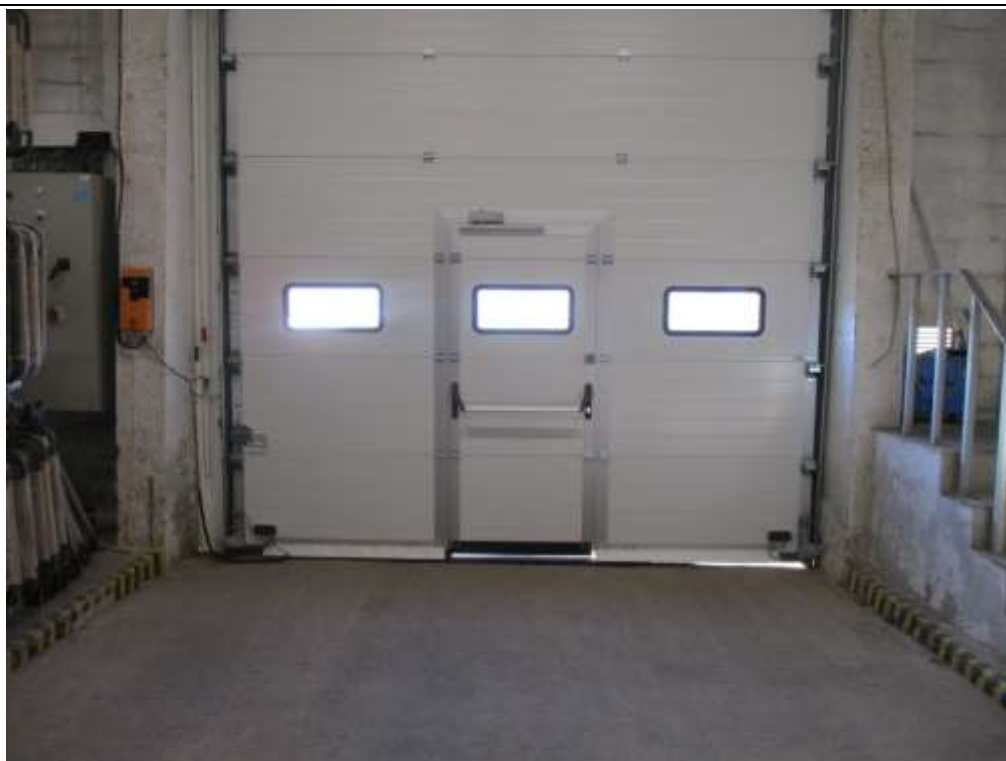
Défaut d'étanchéité - Local 010, au niveau de la porte sectionnelle
